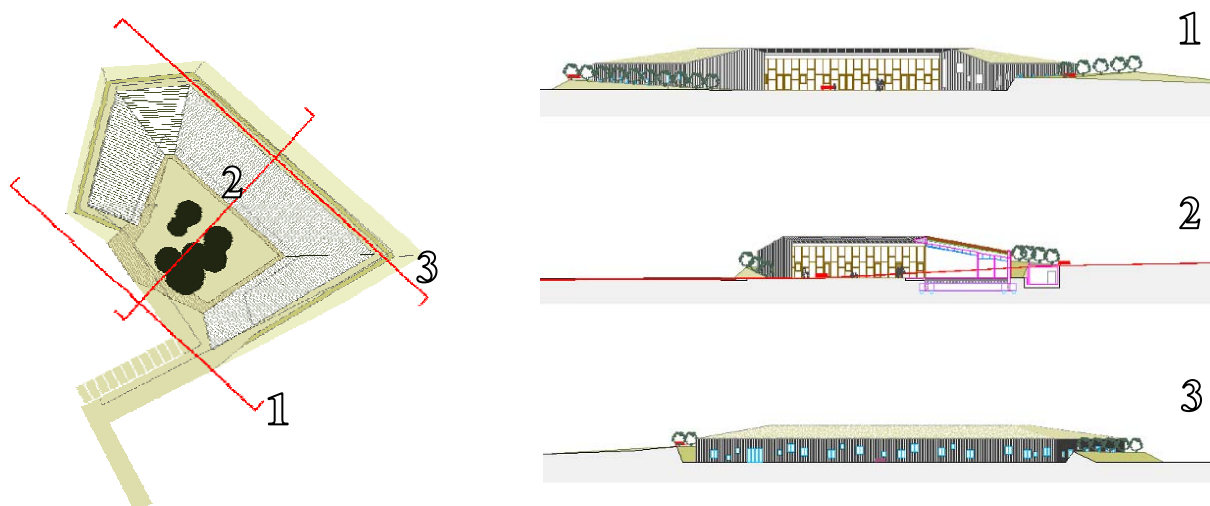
Prospetti riguardanti la struttura prevista per l'asilo
